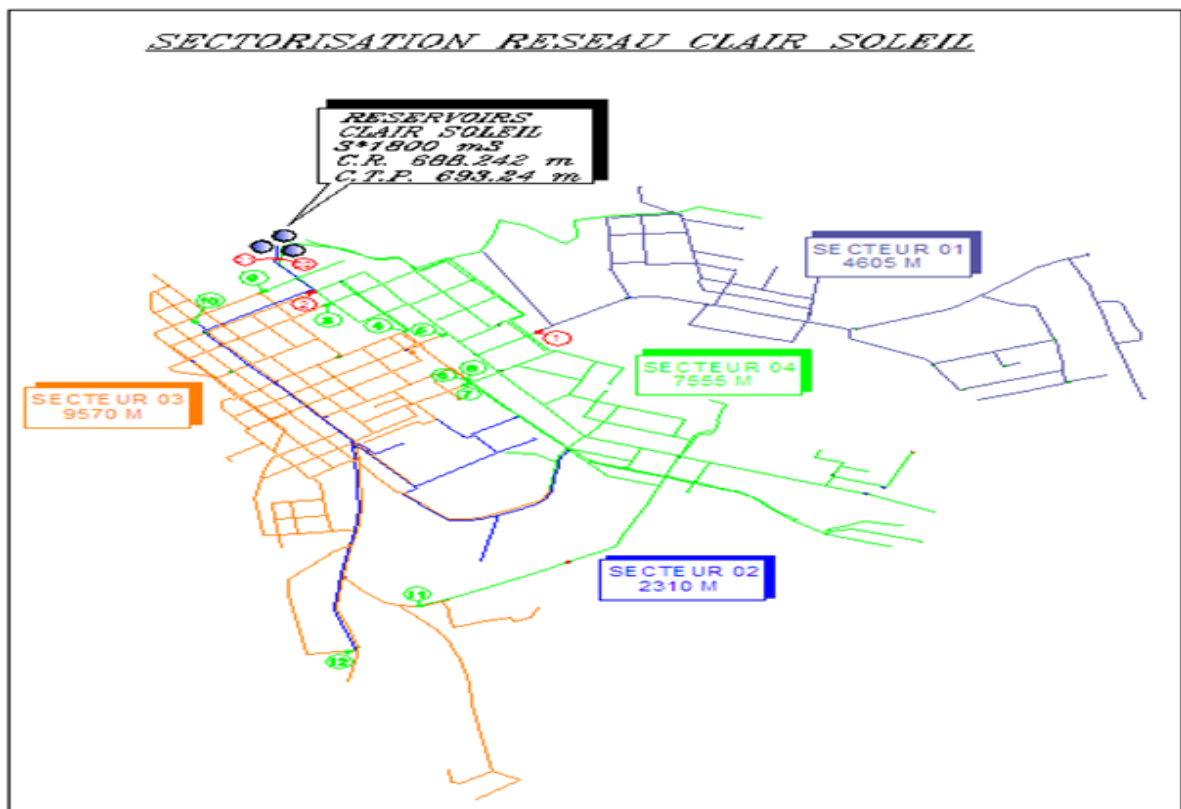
Plan de sectorisation du secteur clair soleil
